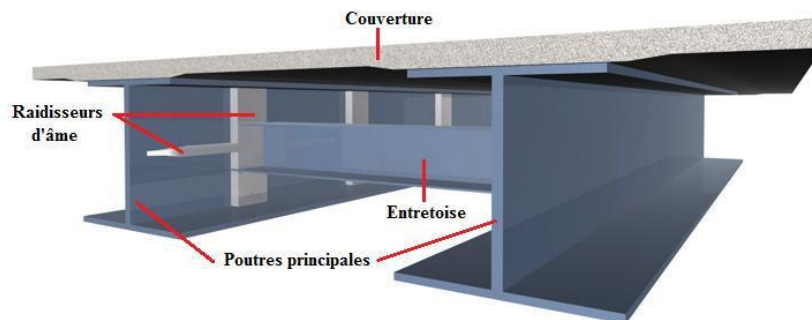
Morphologie d'un pont mixte bipoutres.
